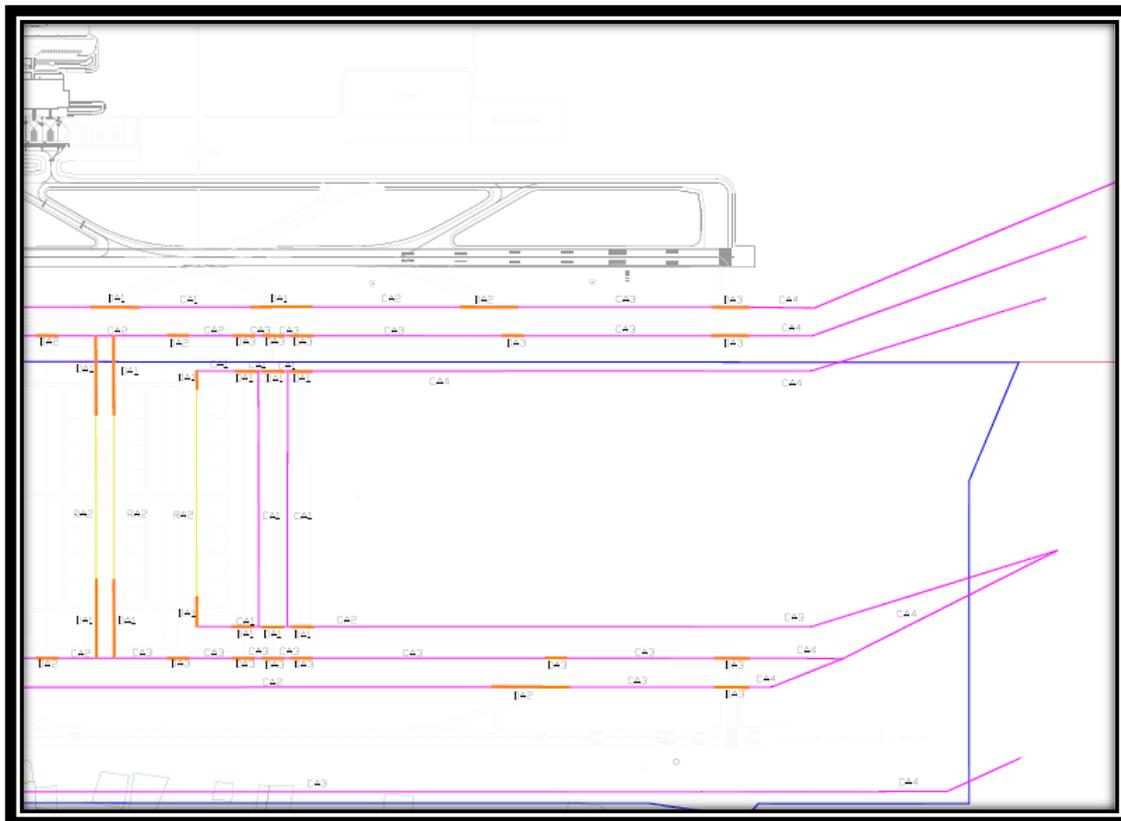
Ubicación de las obras de drenaje pluvial para el presente Proyecto
